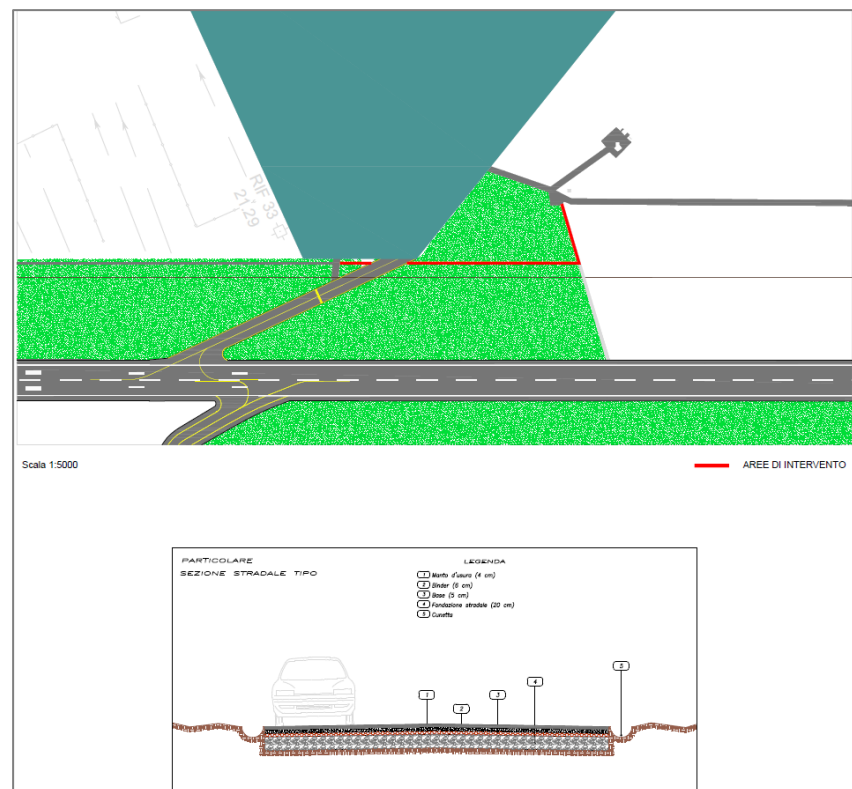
planimetria di intervento di realizzazione strada perimetrale di attraversamento raccordo Echo
